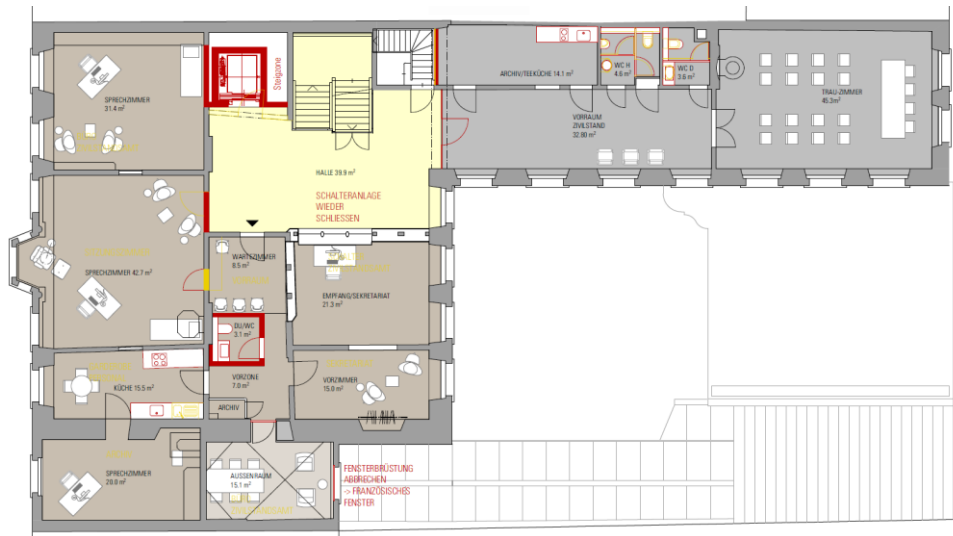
Grundriss 2. Obergeschoss
